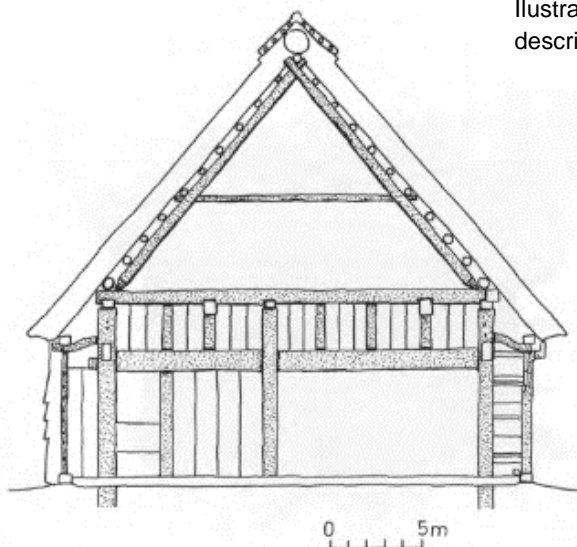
, Sección del edificio en Yamada, Nagao Japón descrito anteriormente Ilustración 37, Fuente ídem 37
